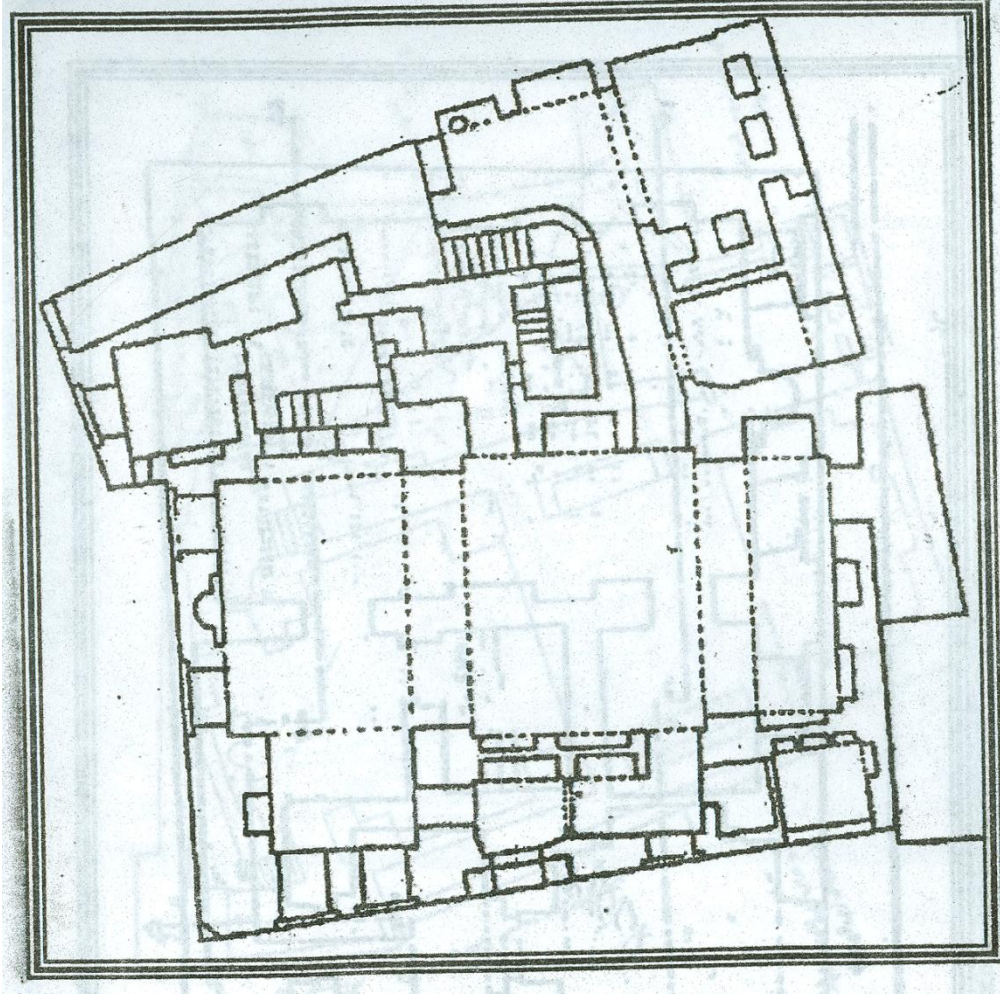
مسقط أفقي لخانقاة فرج بن برقوق. عن: مركز تسجيل الآثار
